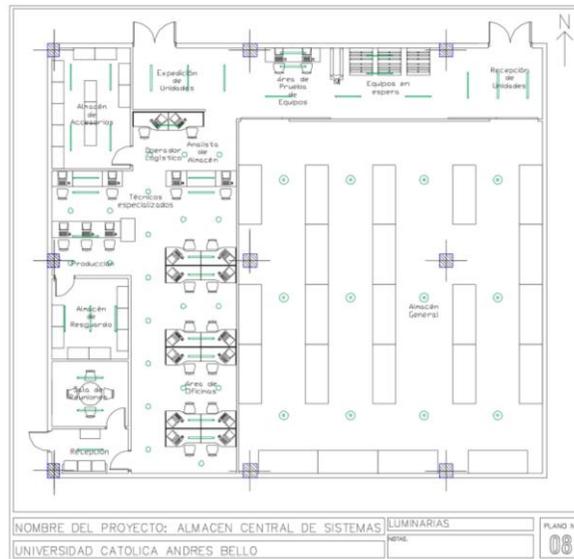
Plano de ubicación de las luminarias. Fuente: Propia.
